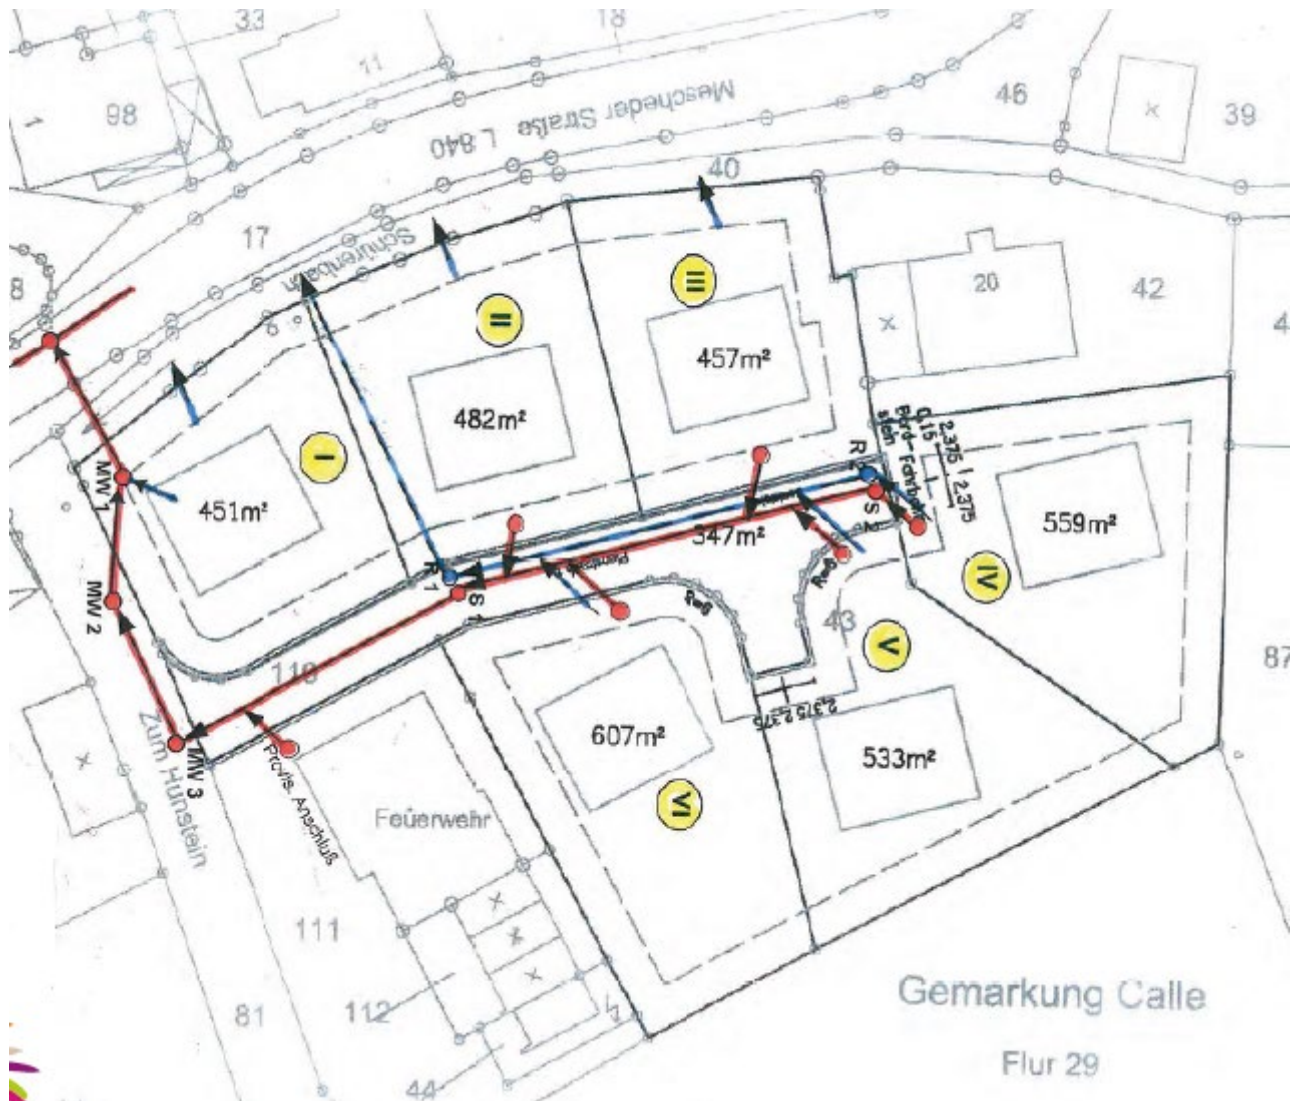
Geplante Entwässerung des Baugebietes Zum Hunstein (Prinzipkizze – Änderungen noch möglich)
